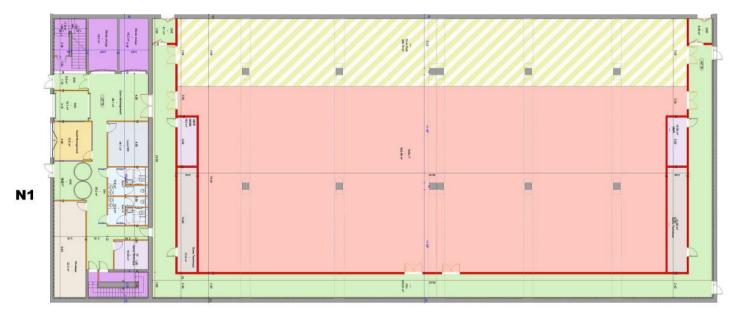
Plan étage R+1 d'un bâtiment datacenter
